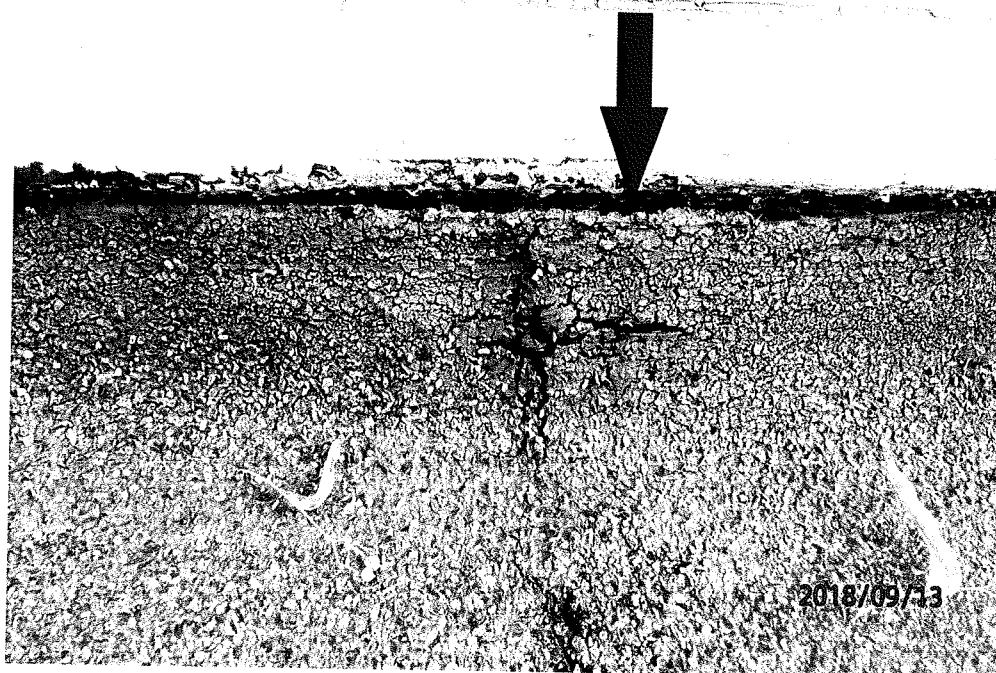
Wadliwe wykonanie izolacji wokół wewnętrznego wpustu dachowego. Zaznaczono miejsce wnikania wód opadowych pod papę wpustu.
